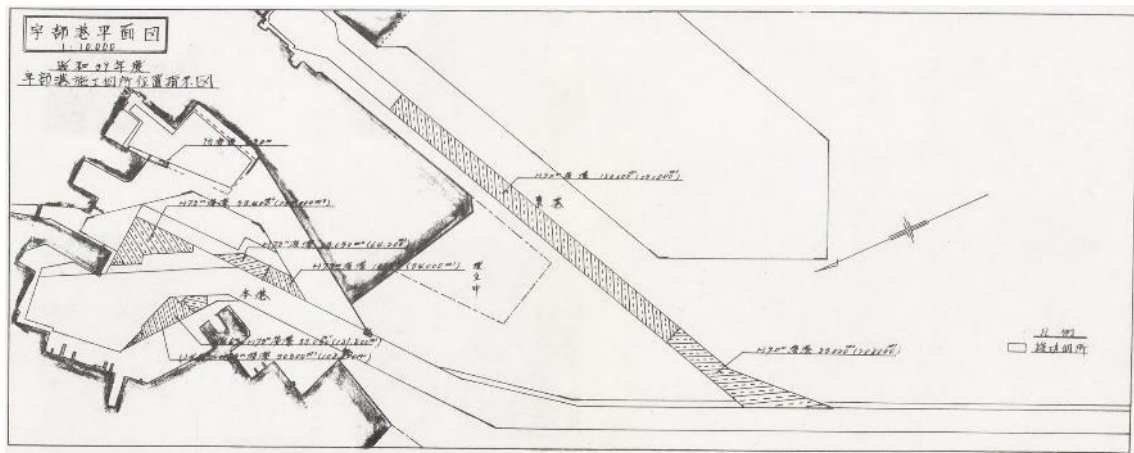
宇部港工事平面図 (1964年) [541, p. 59]
